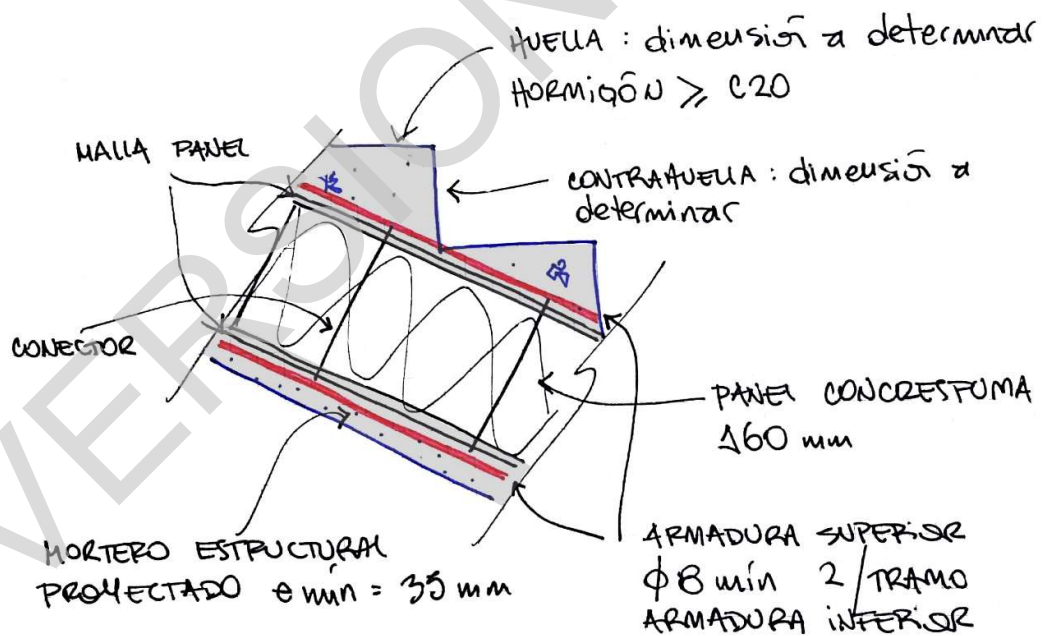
Detalles de armado de escaleras (esquema y croquis ilustrativos)
